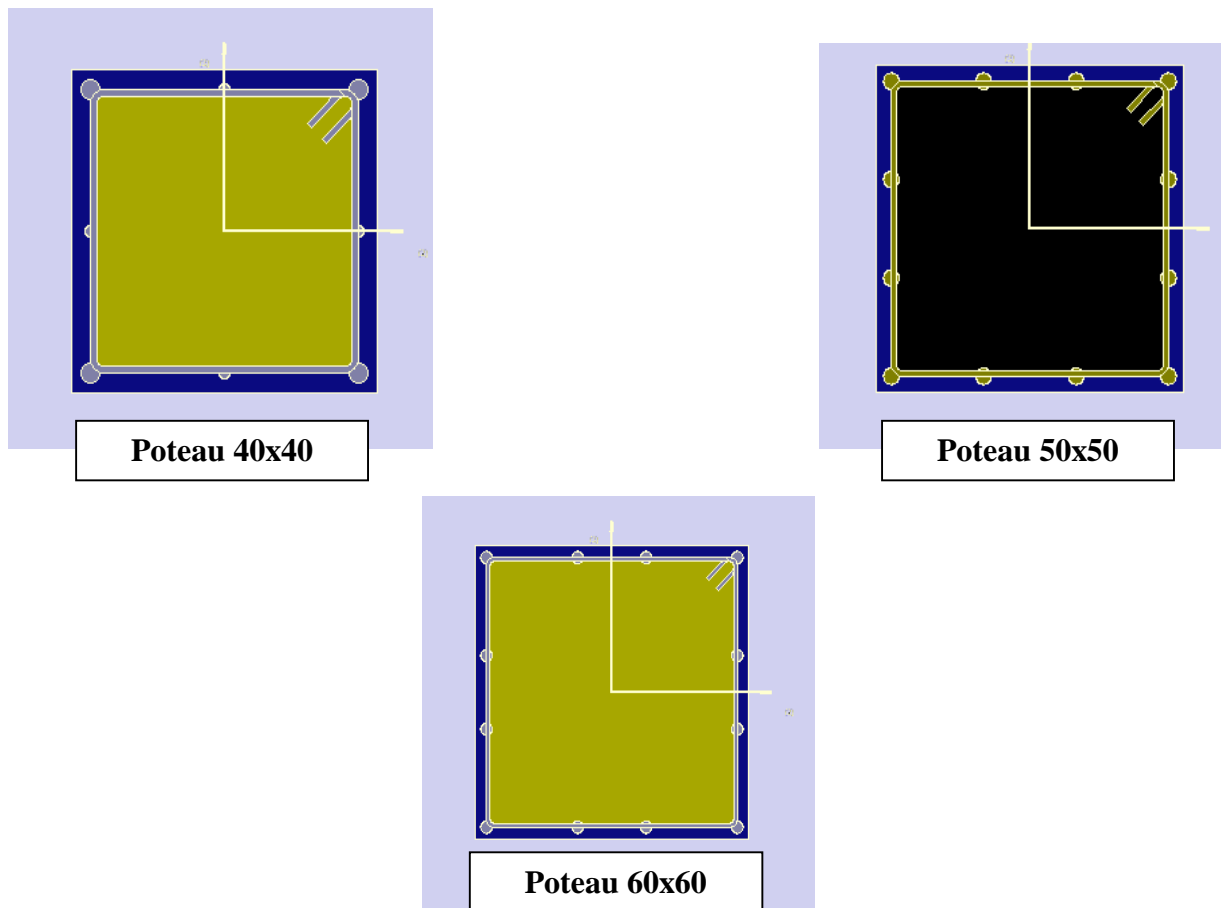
Les sections courantes des poteaux dans le bâtiment de 9 étages.[9]
